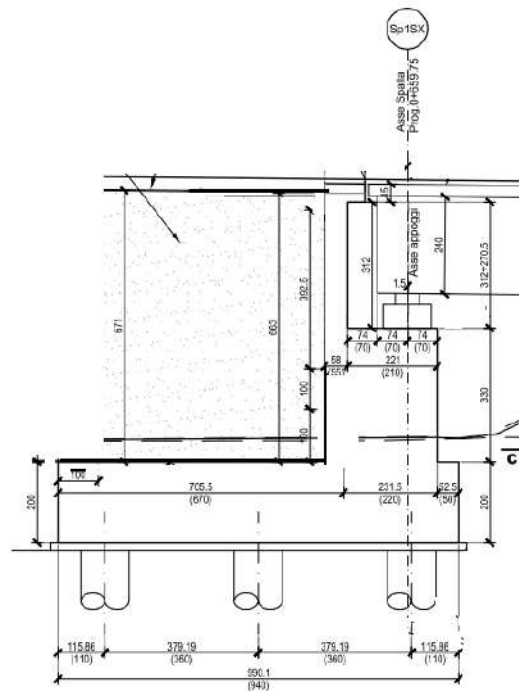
Sezione trasversale spalle SP1 ed SP2
